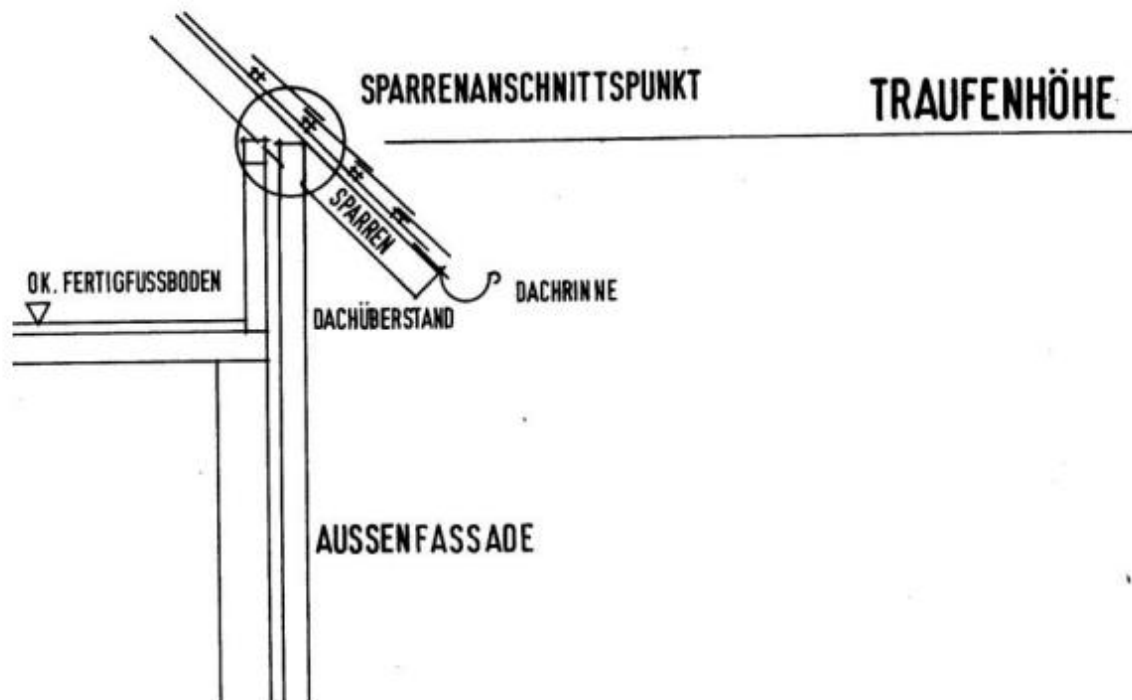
Traufhöhe – Sparrenanschnittspunkt
